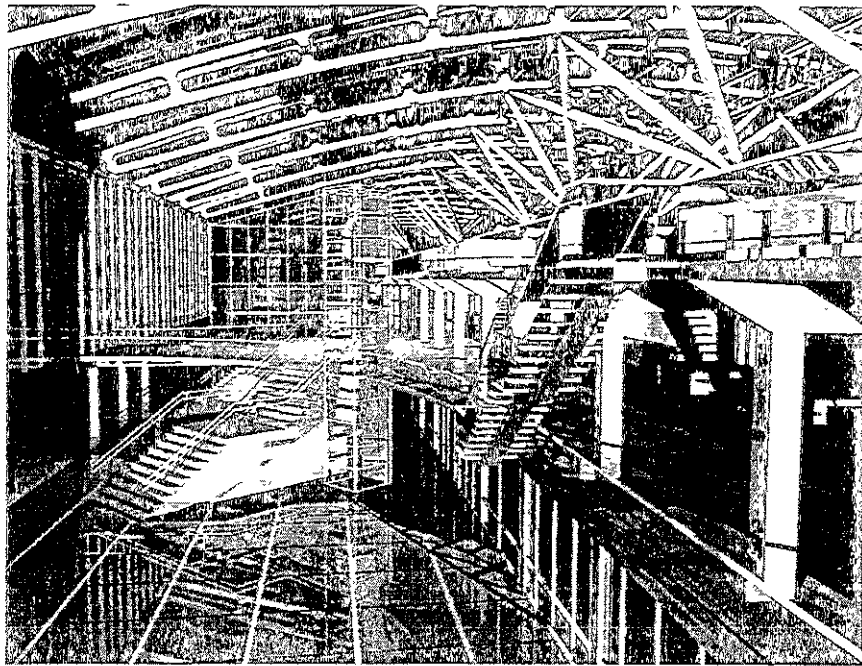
Proyecto de Aeropuerto (interior) desarrollado en AllPlan
